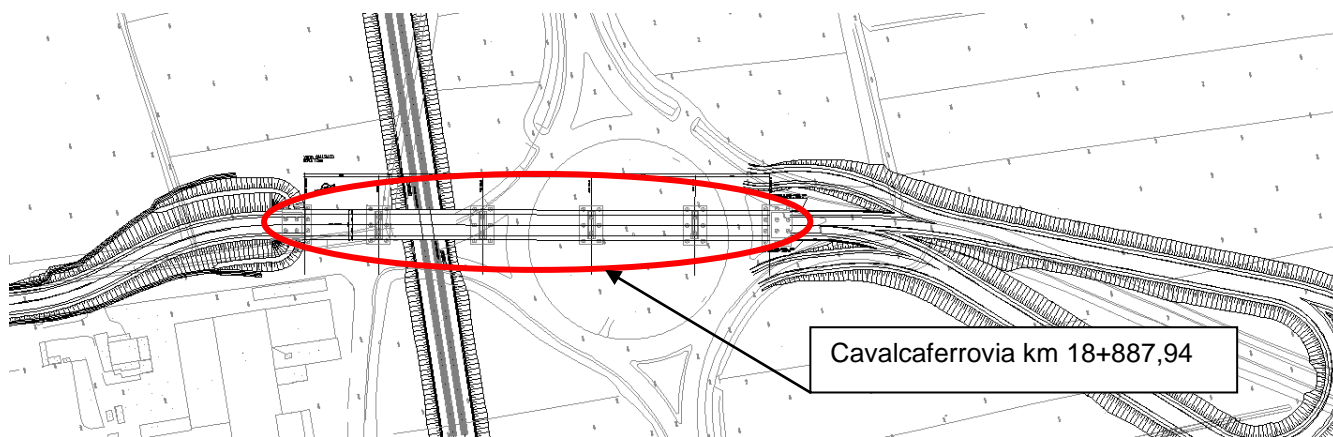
Stralcio planimetrico – ubicazione opera d’arte
